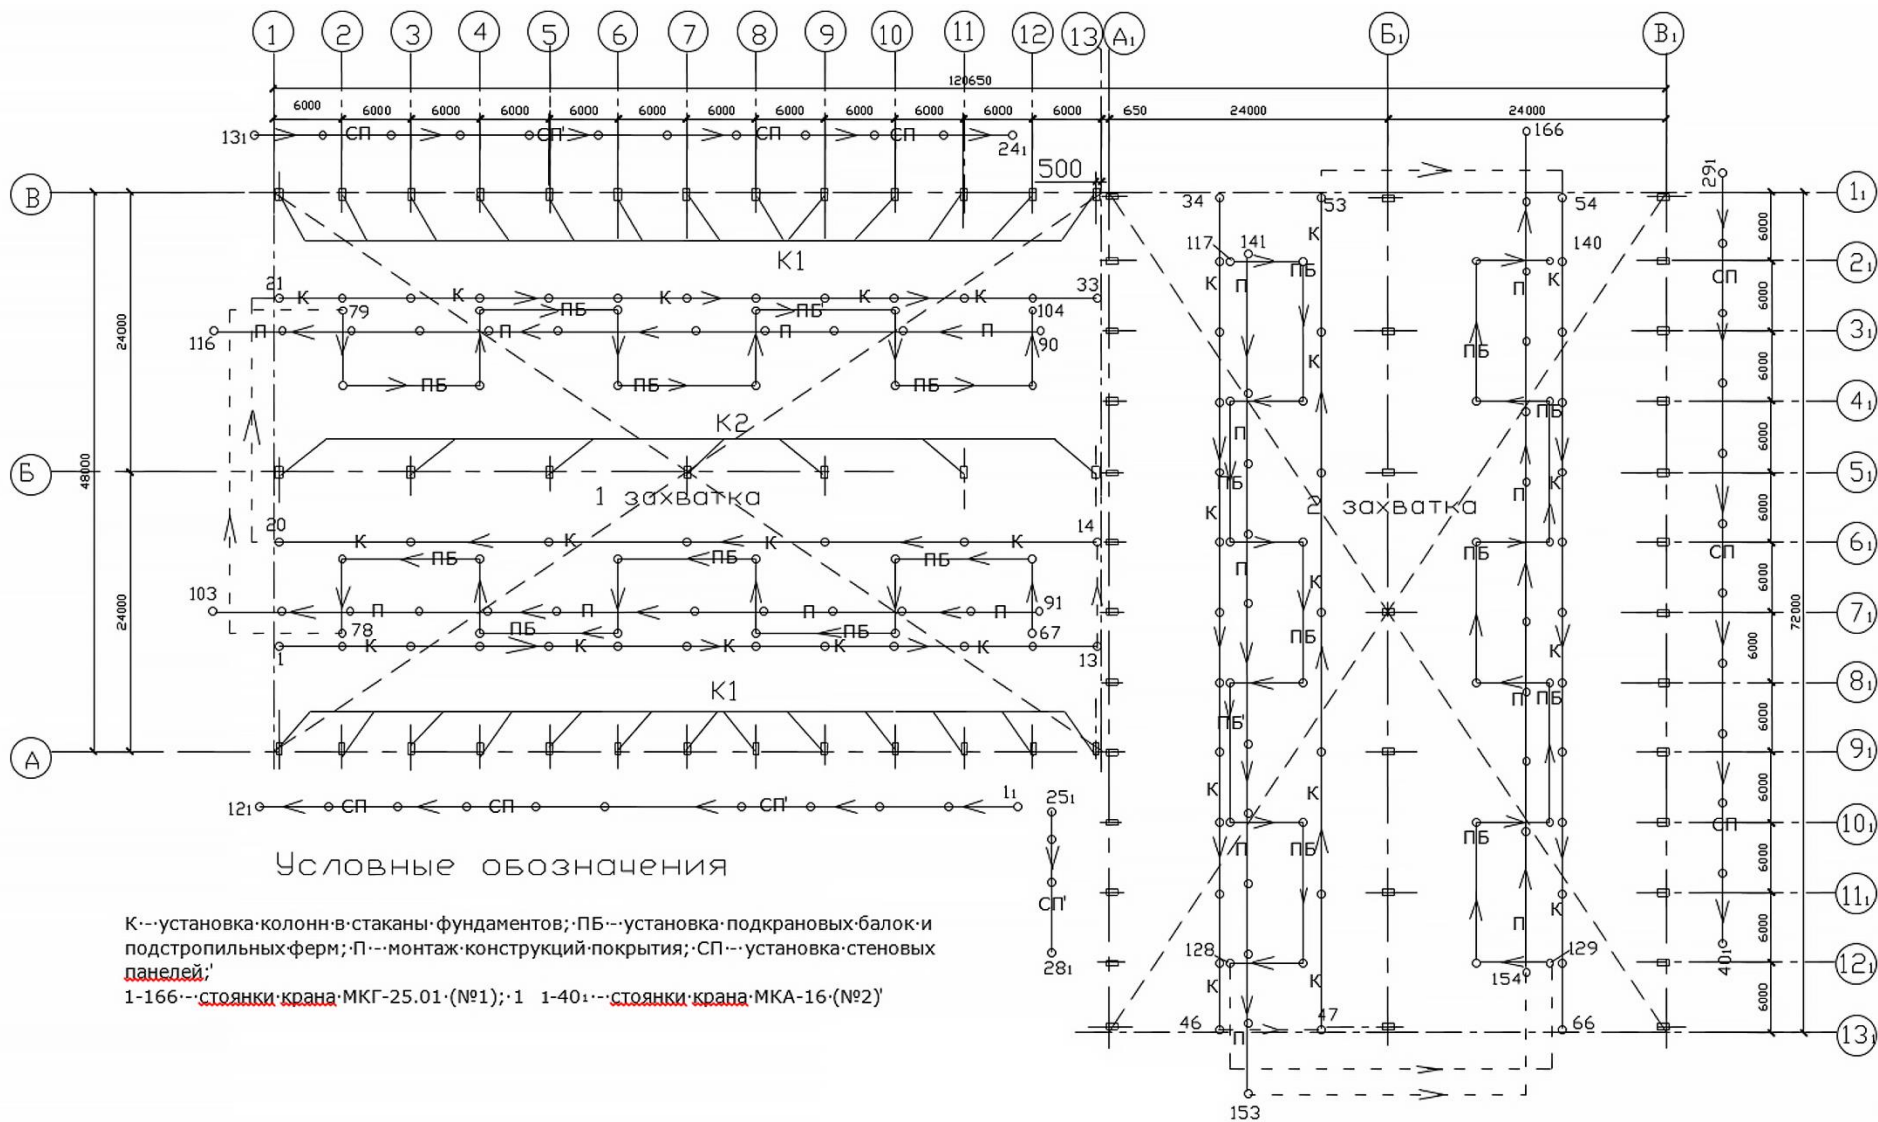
Схема движения кранов при монтаже конструкций здания
